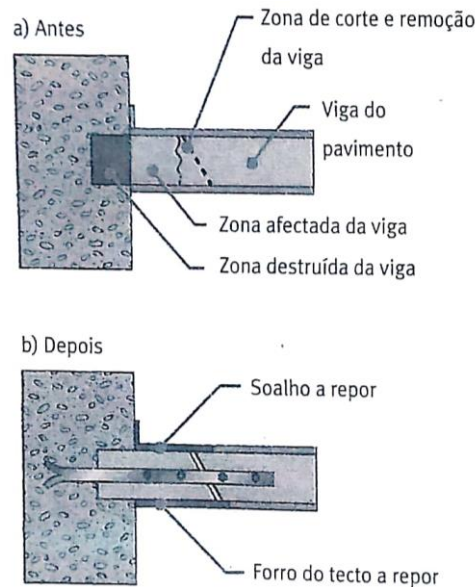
Substituição de topo de viga de madeira de um pavimento [9]
